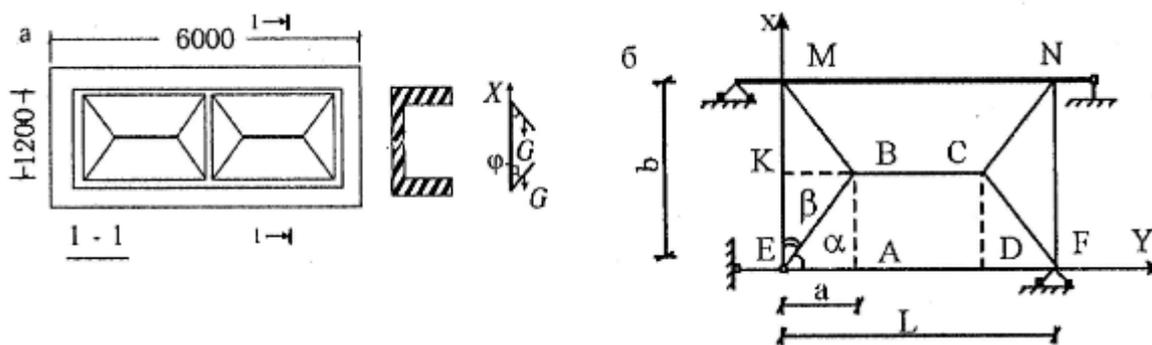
ОРК с шарнирами по контуру типа «конверт»: а – конструкция; б – расчетная схема
